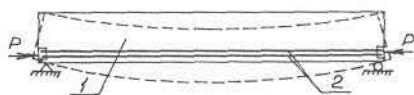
(1 — усиливаемая балка, 2 — затяжка)
